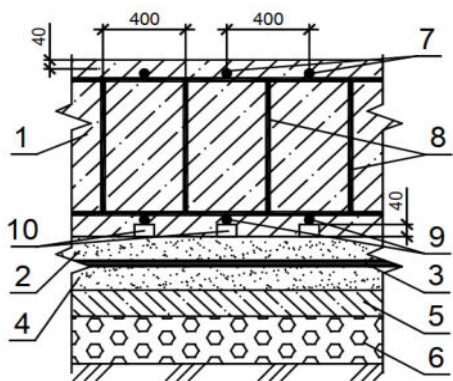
Конструкция классической монолитной железобетонной фундаментной плиты:
